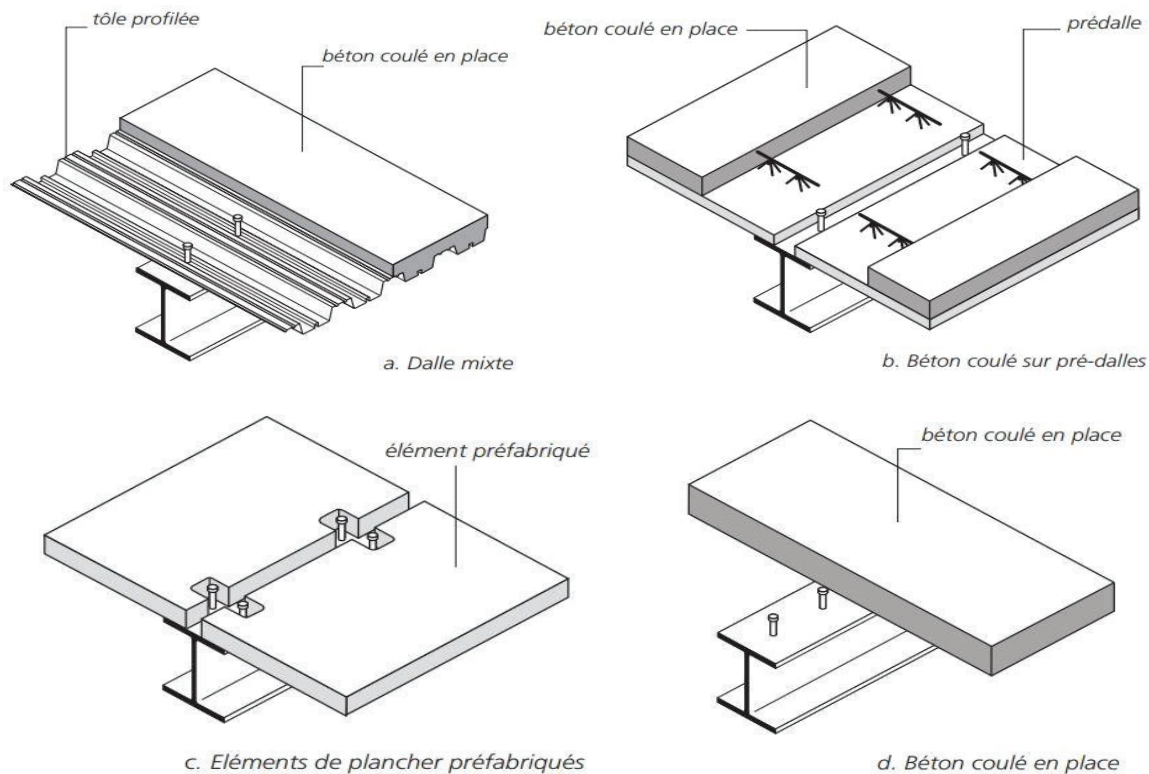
Divers types de planchers dans les poutres mixtes [INF 1994]
